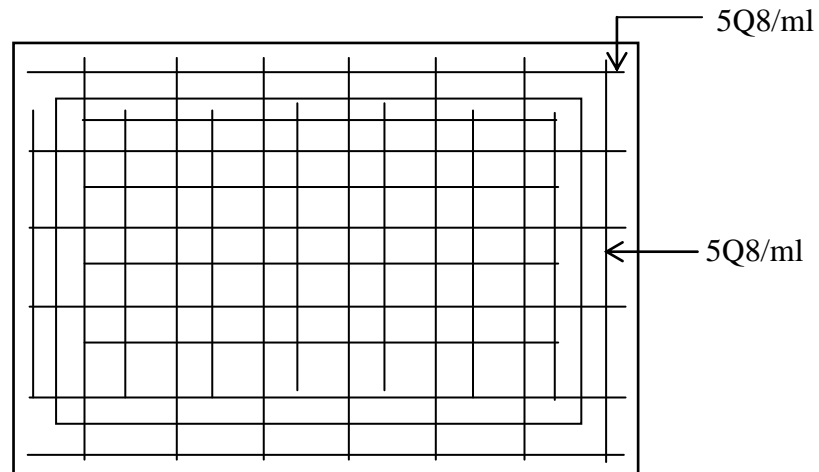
Dessin Ferrailage Inférieur du panneau de la dalle pleine.
